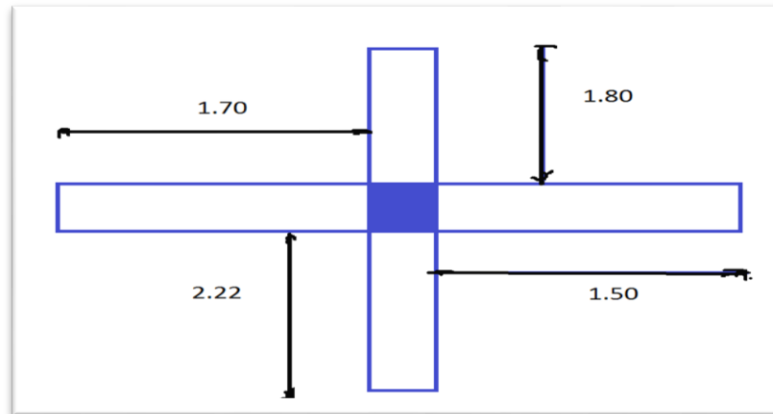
Surface du plancher sur le poteau(pot :1.D)
